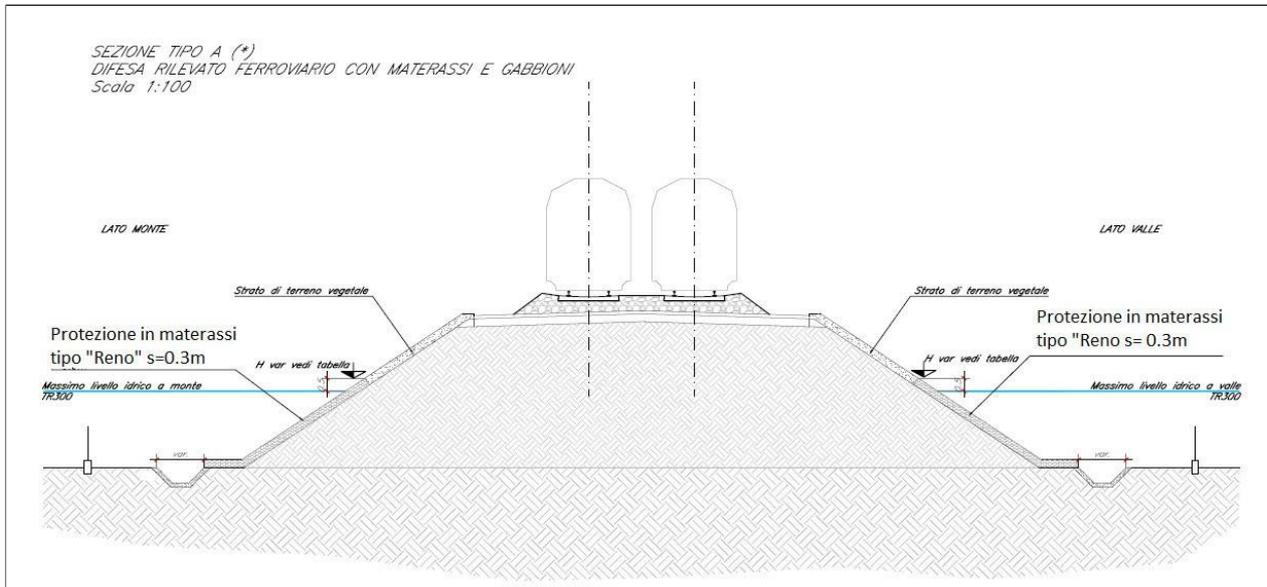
Sezione tipo opere di presidio idraulico rilevato
